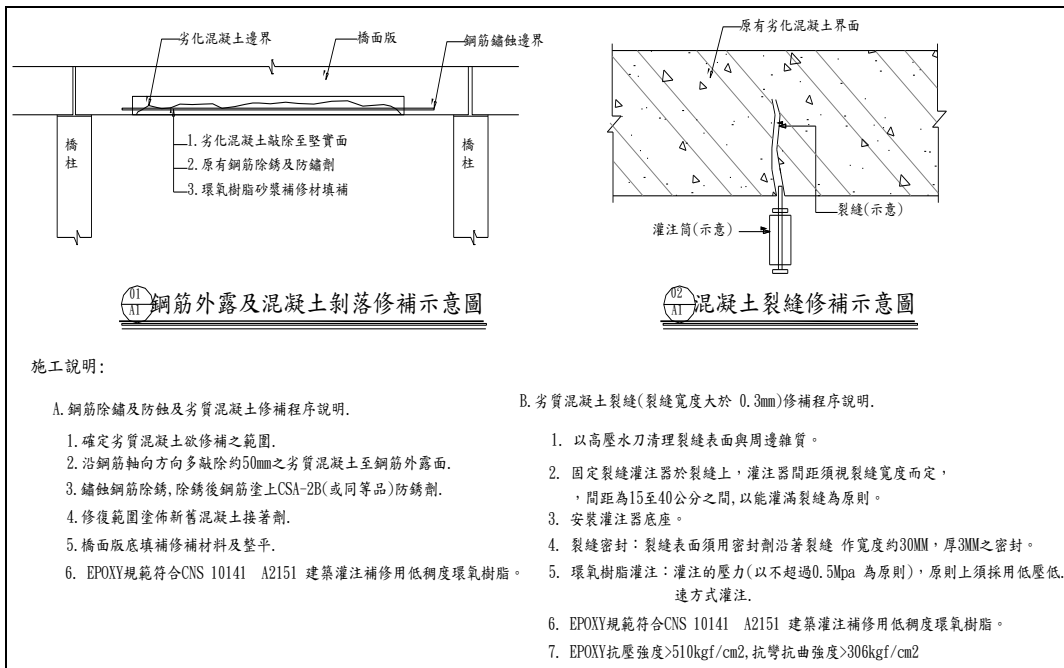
橋梁工程混凝土裂縫及鋼筋外露耐震修補示意圖
